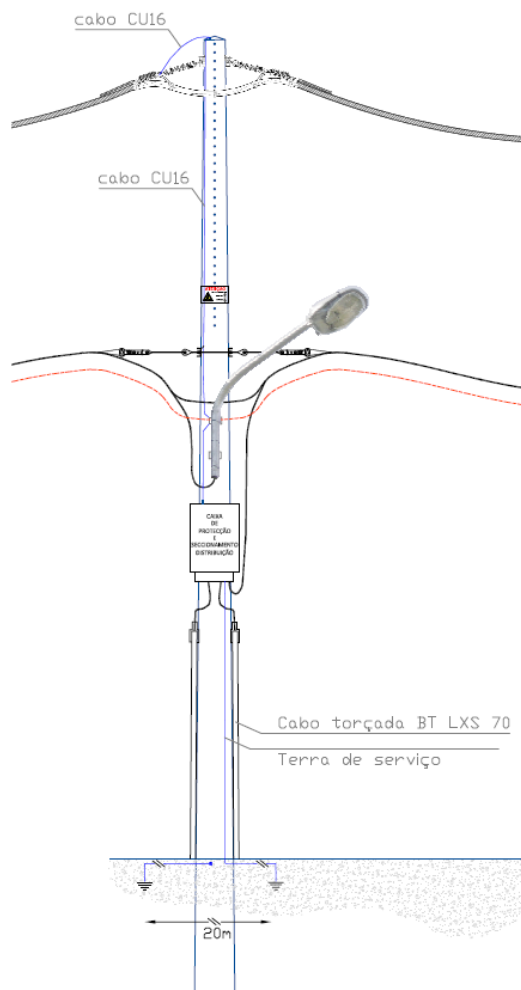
Pormenor da ligação à terra das ferragens BT/IP, num apoio da rede de MT
